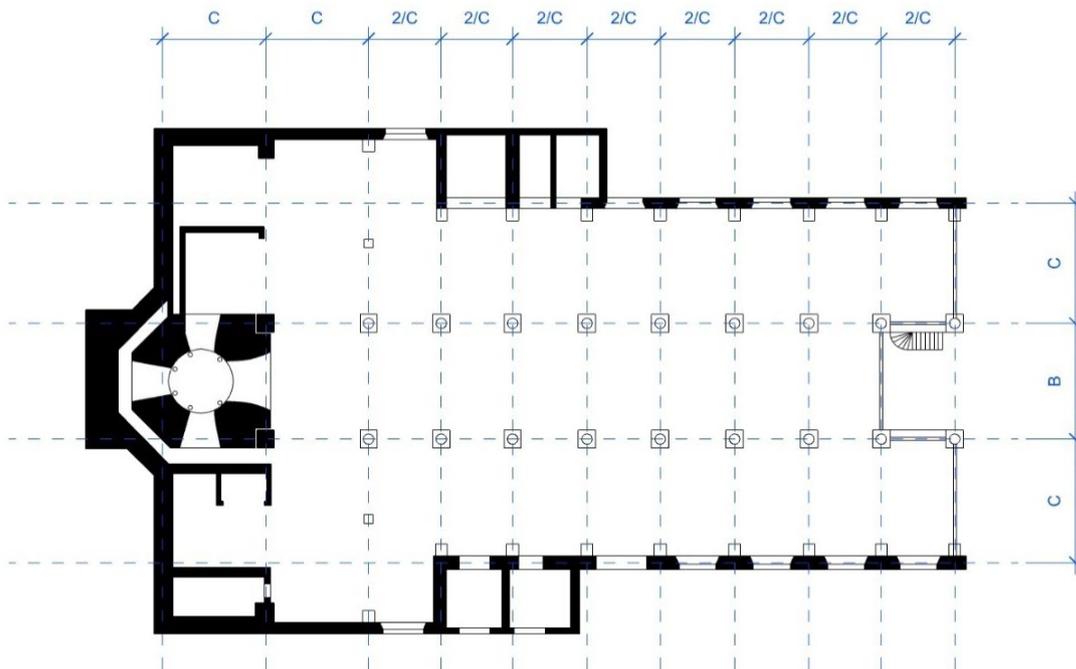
Abstandsproportionen im Grundriss der Sayner Hütte
